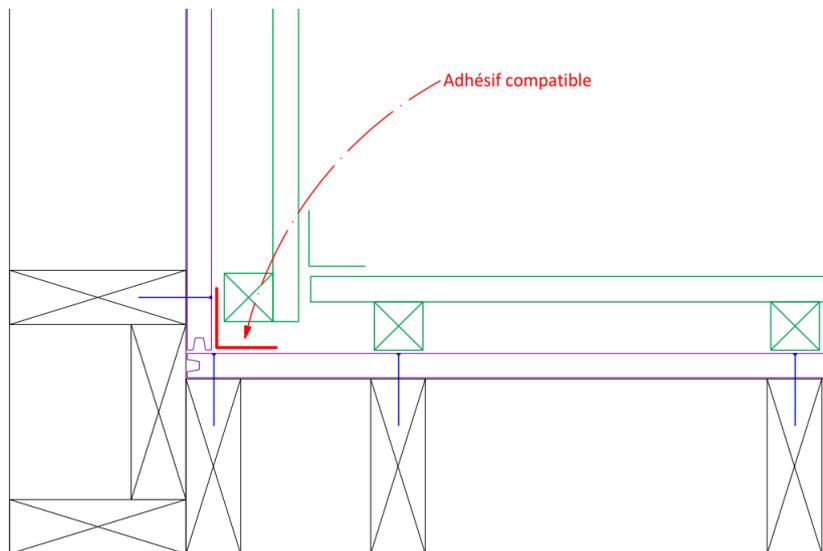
Joint vertical entre panneaux AGEPAN DWD Protect – Fonction de voile travaillant
